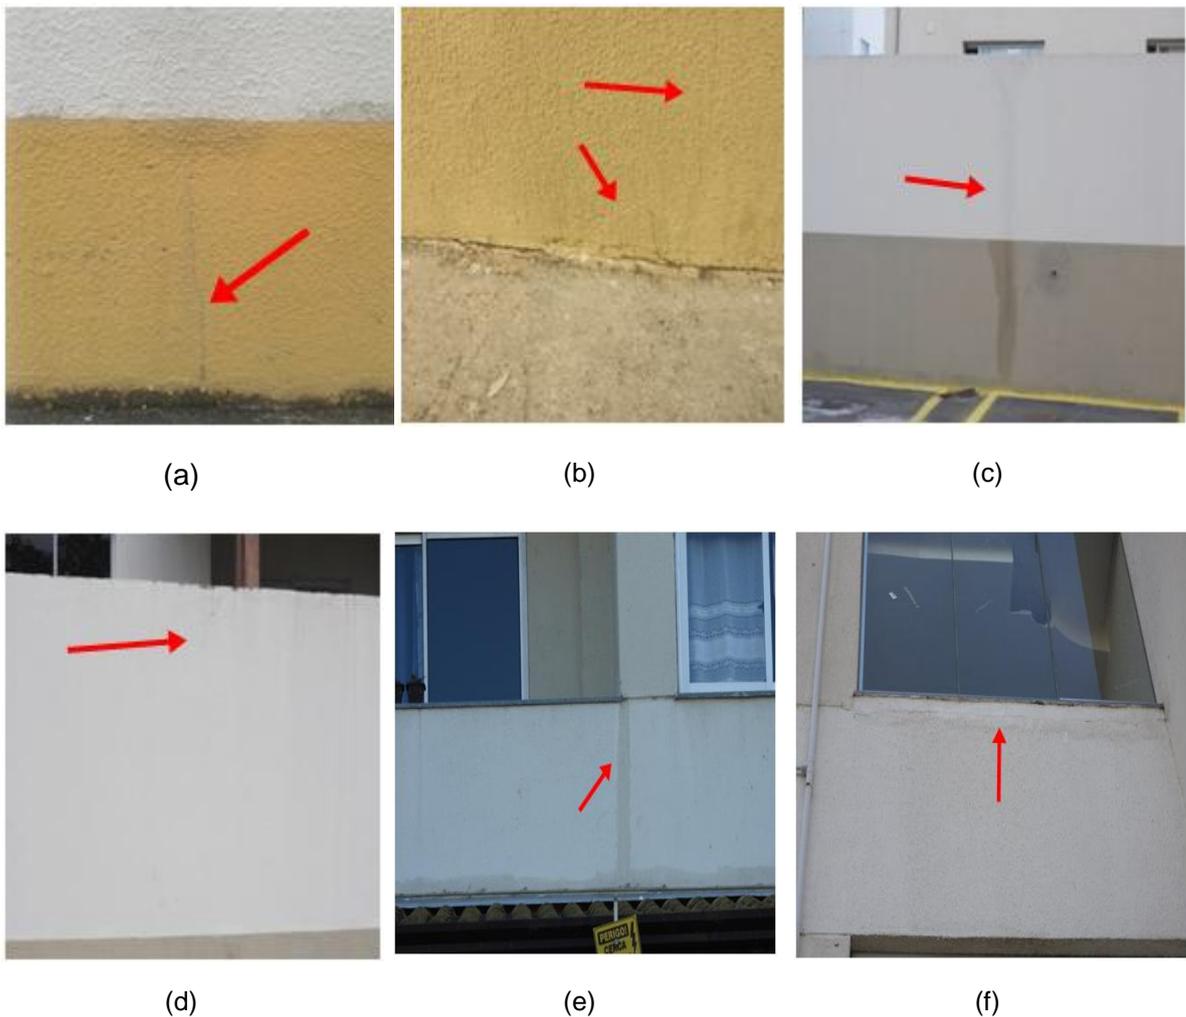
(a) Fissura vertical no muro da torre B; (b) Fissura na parede do salão de festas; (c) Fissura vertical no muro da torre E; (d) Fissura vertical no muro da torre H
